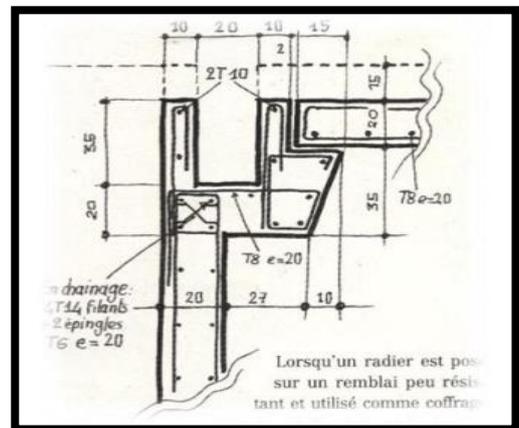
Détail du ferrailage de l'appui d'une plage sur un chéneau de piscine à débordement
